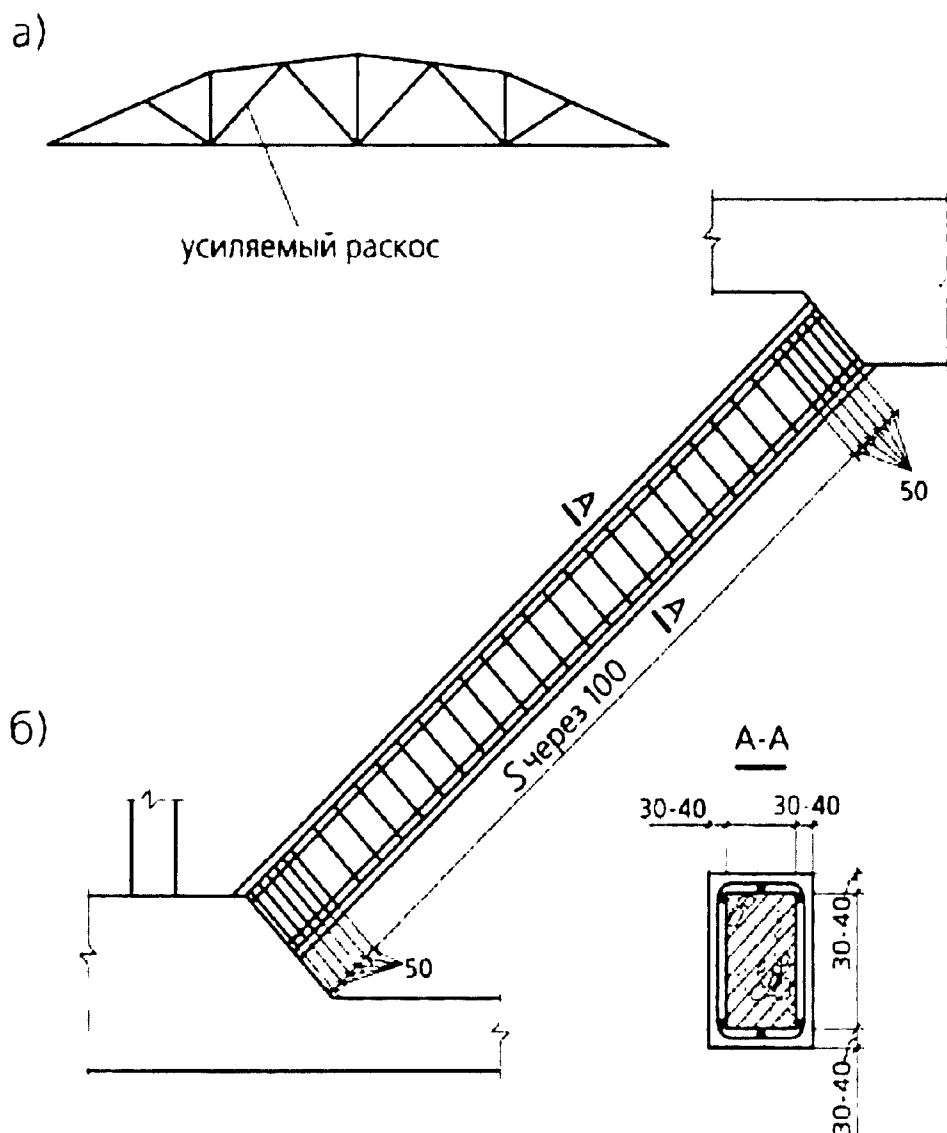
Усиление сжатого раскоса фермы монолитной железобетонной обоймой: а - схема фермы; б - усиление сжатого раскоса
